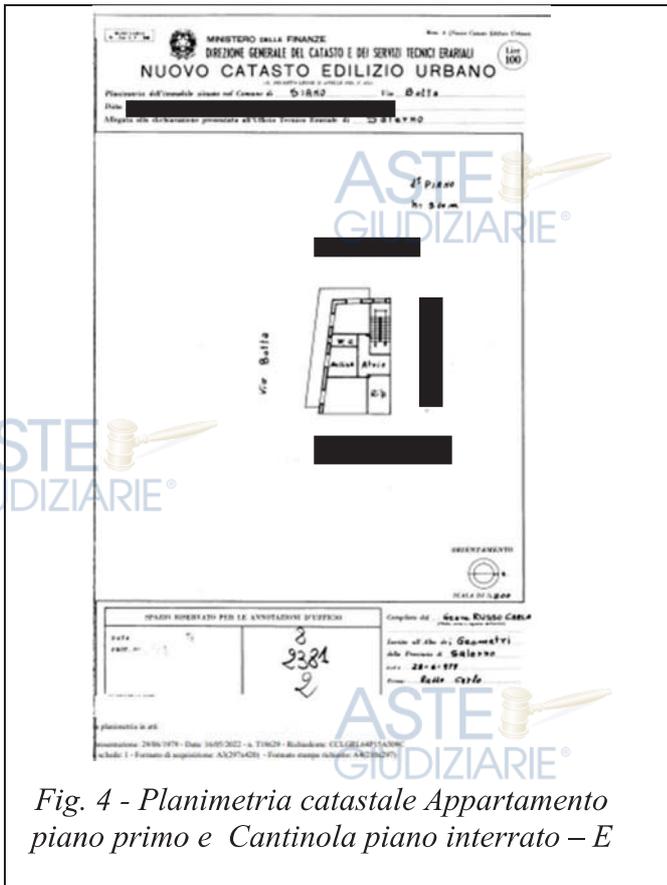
Planimetria catastale Appartamento piano primo e Cantinola piano interrato – E
